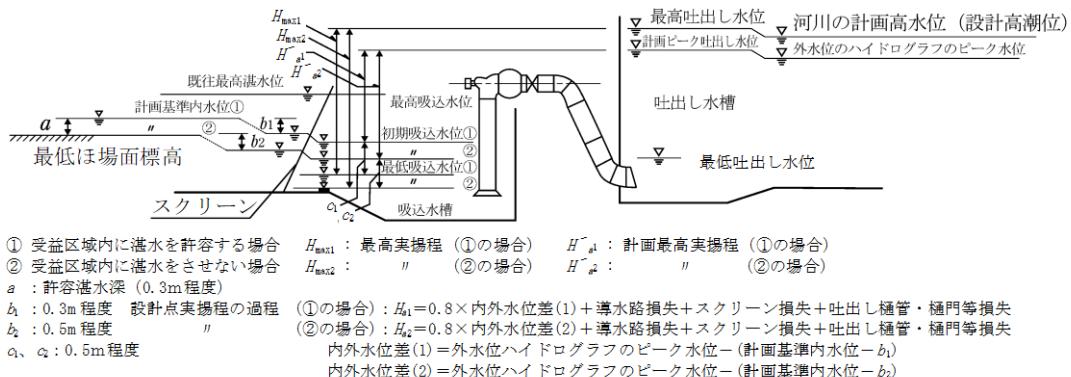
洪水時排水ポンプの設計水位及び実揚程
